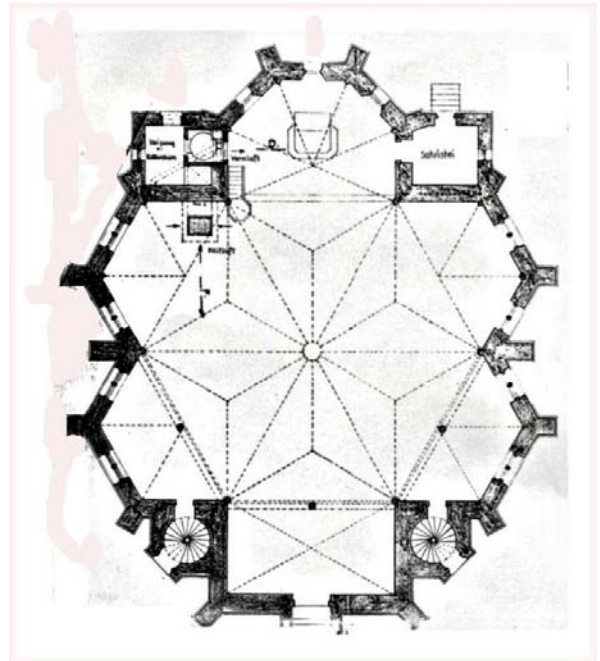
Grundriss, Bauaufnahme 1935
